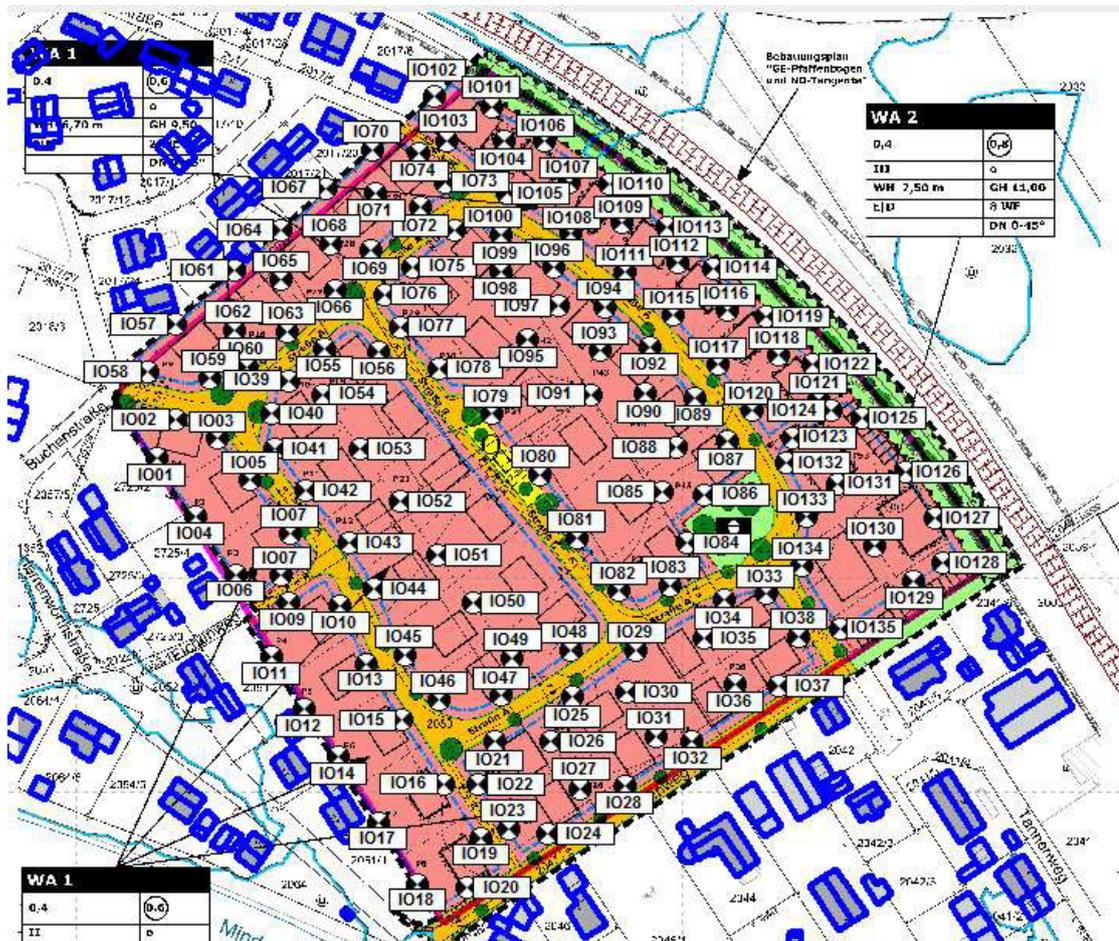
Bebauungsplan „Ermle IV“ gem. [b] mit Lage der Immissionsorte
